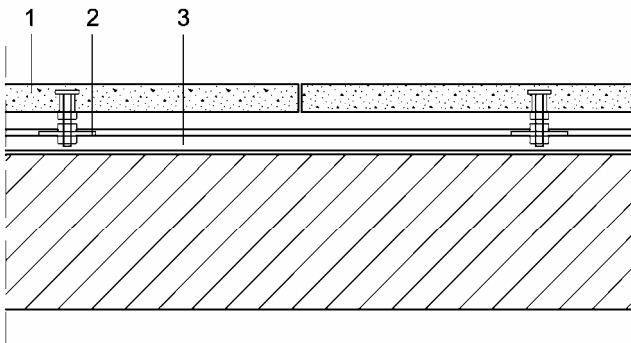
Sección horizontal de fachada sistema Panel ΩZ.
